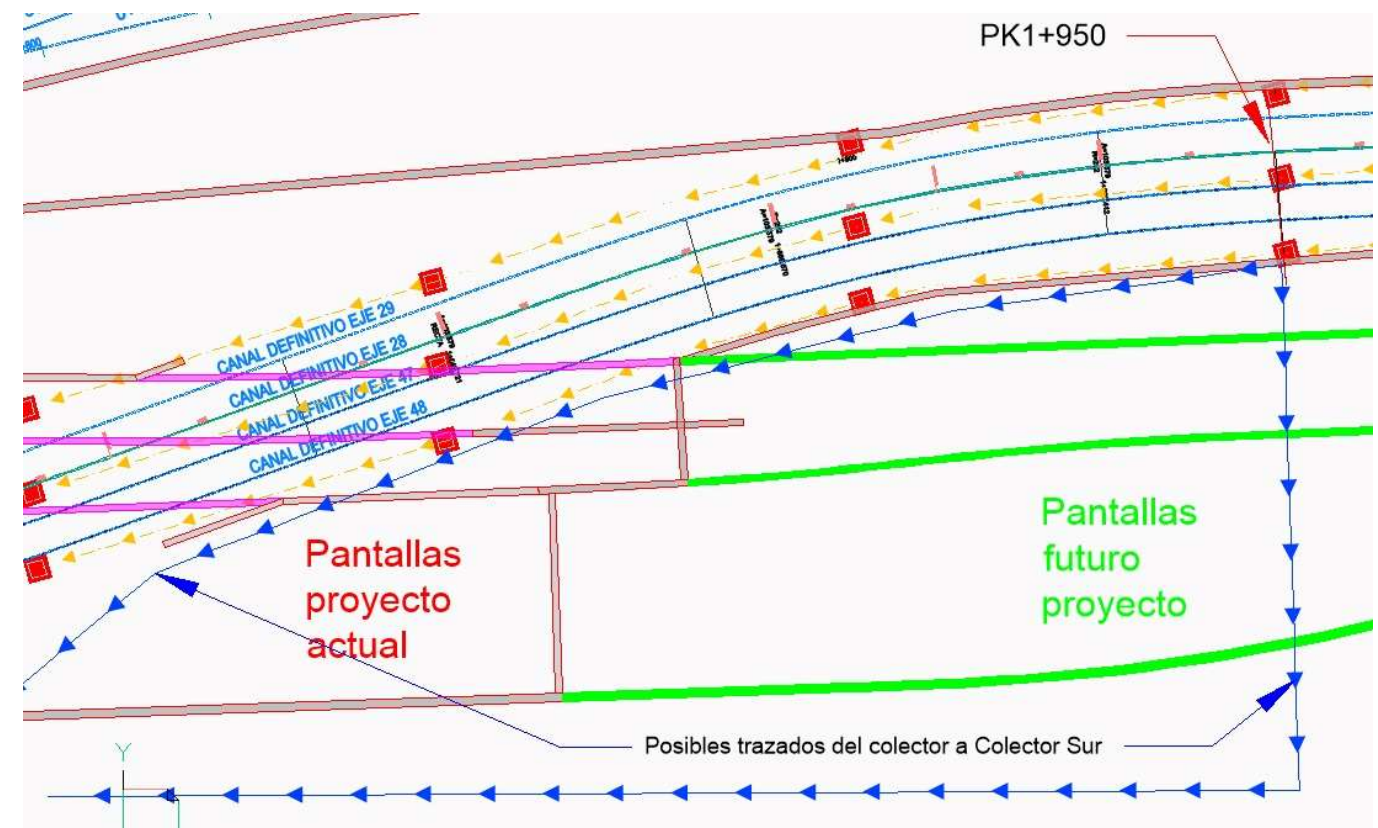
Detalle de imposibilidad de la conexión por el trazado de los túneles futuros. Fuente: elaboración propia con planos de la oficina técnica
